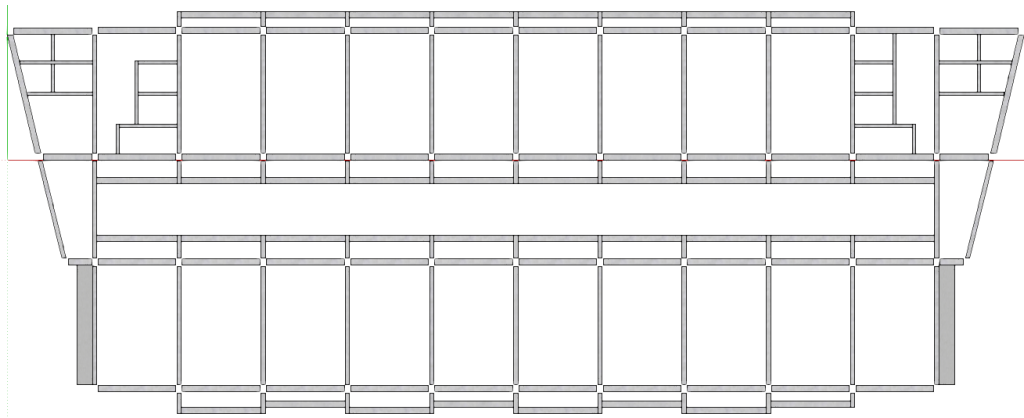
10 denah Lt 4 bangunan kampus Stital.
